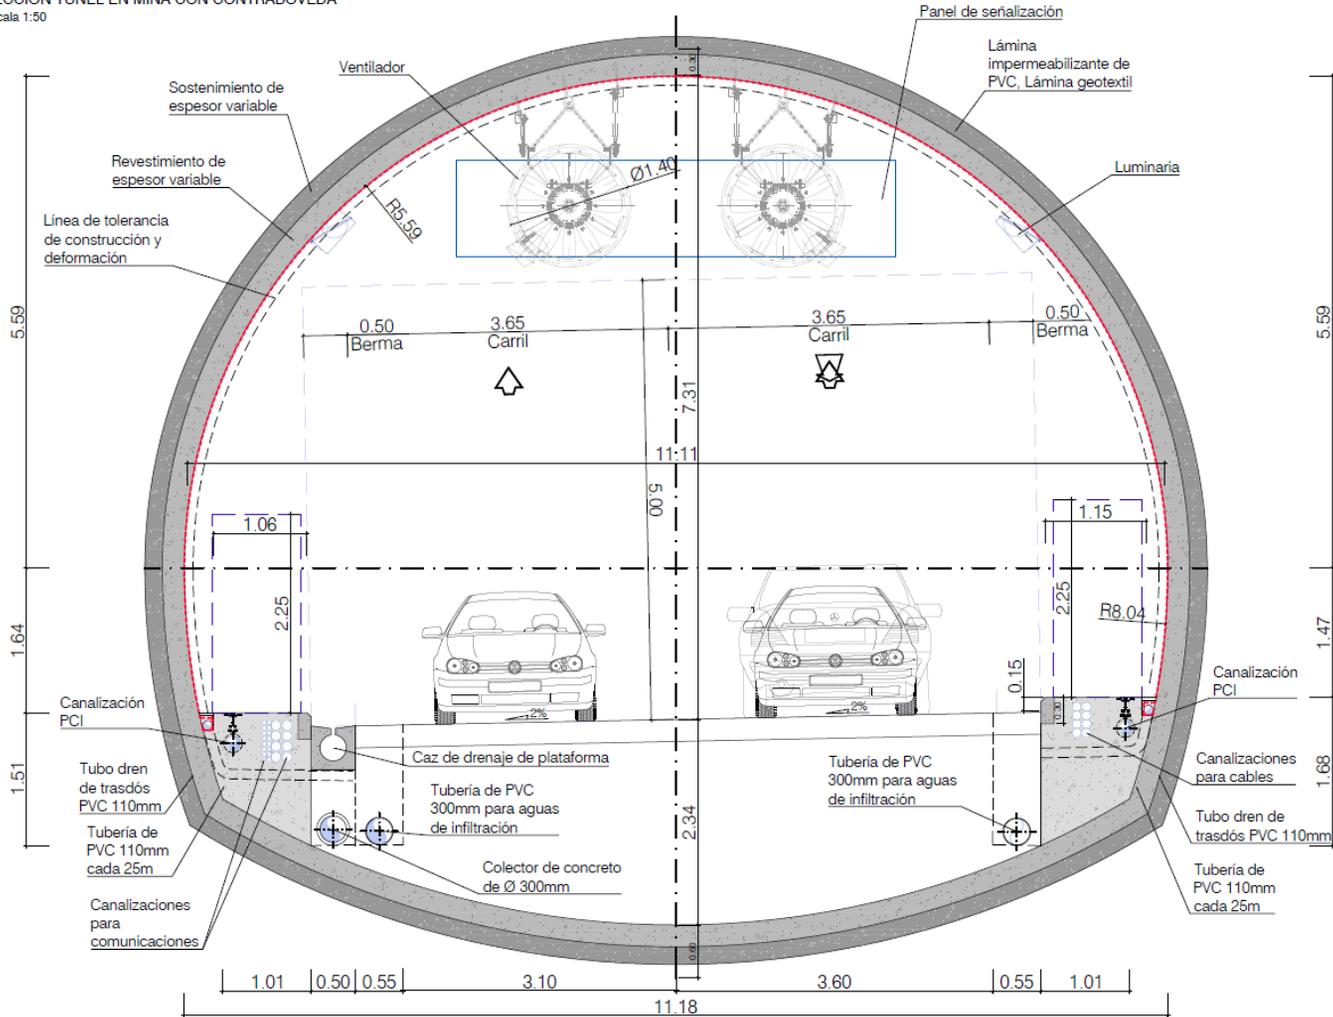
Sección transversal tipo para túnel (1 de 2)
